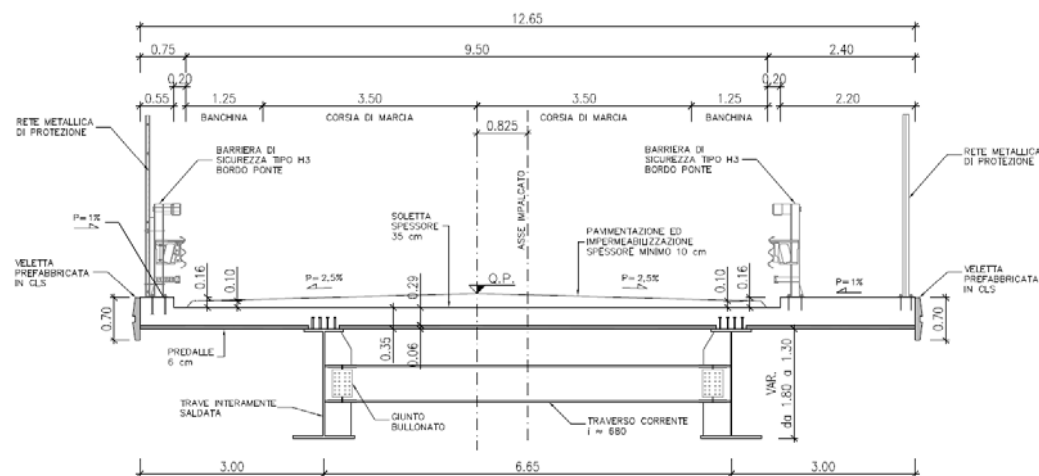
Sezione trasversale impalcato per cavalcavia B=12.65m
